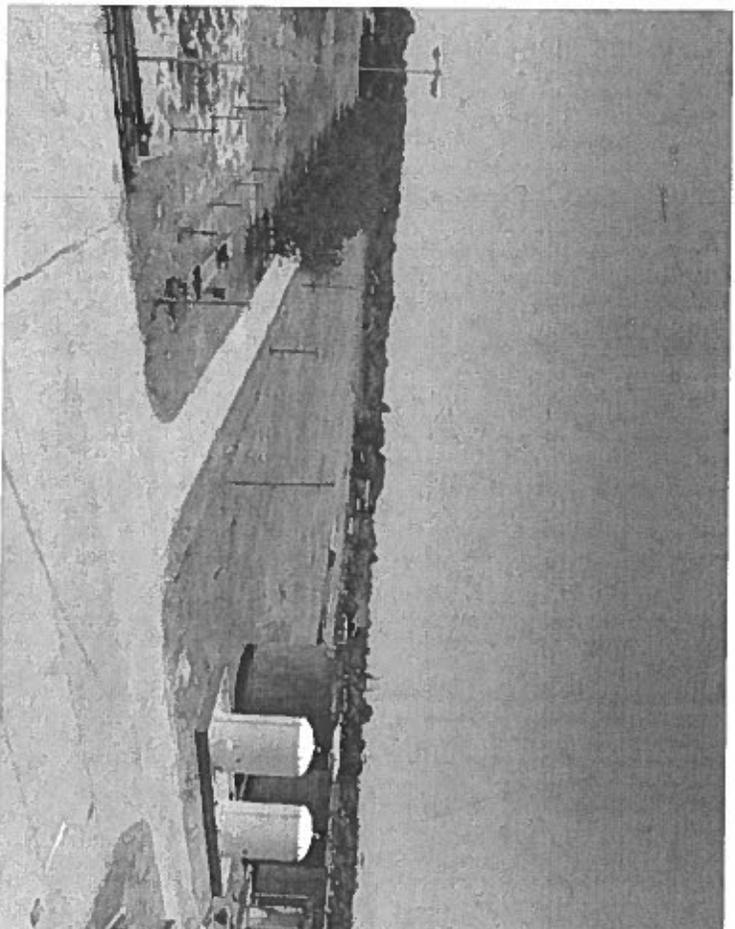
Vista del sector donde se ejecutará la ampliación de la Planta
